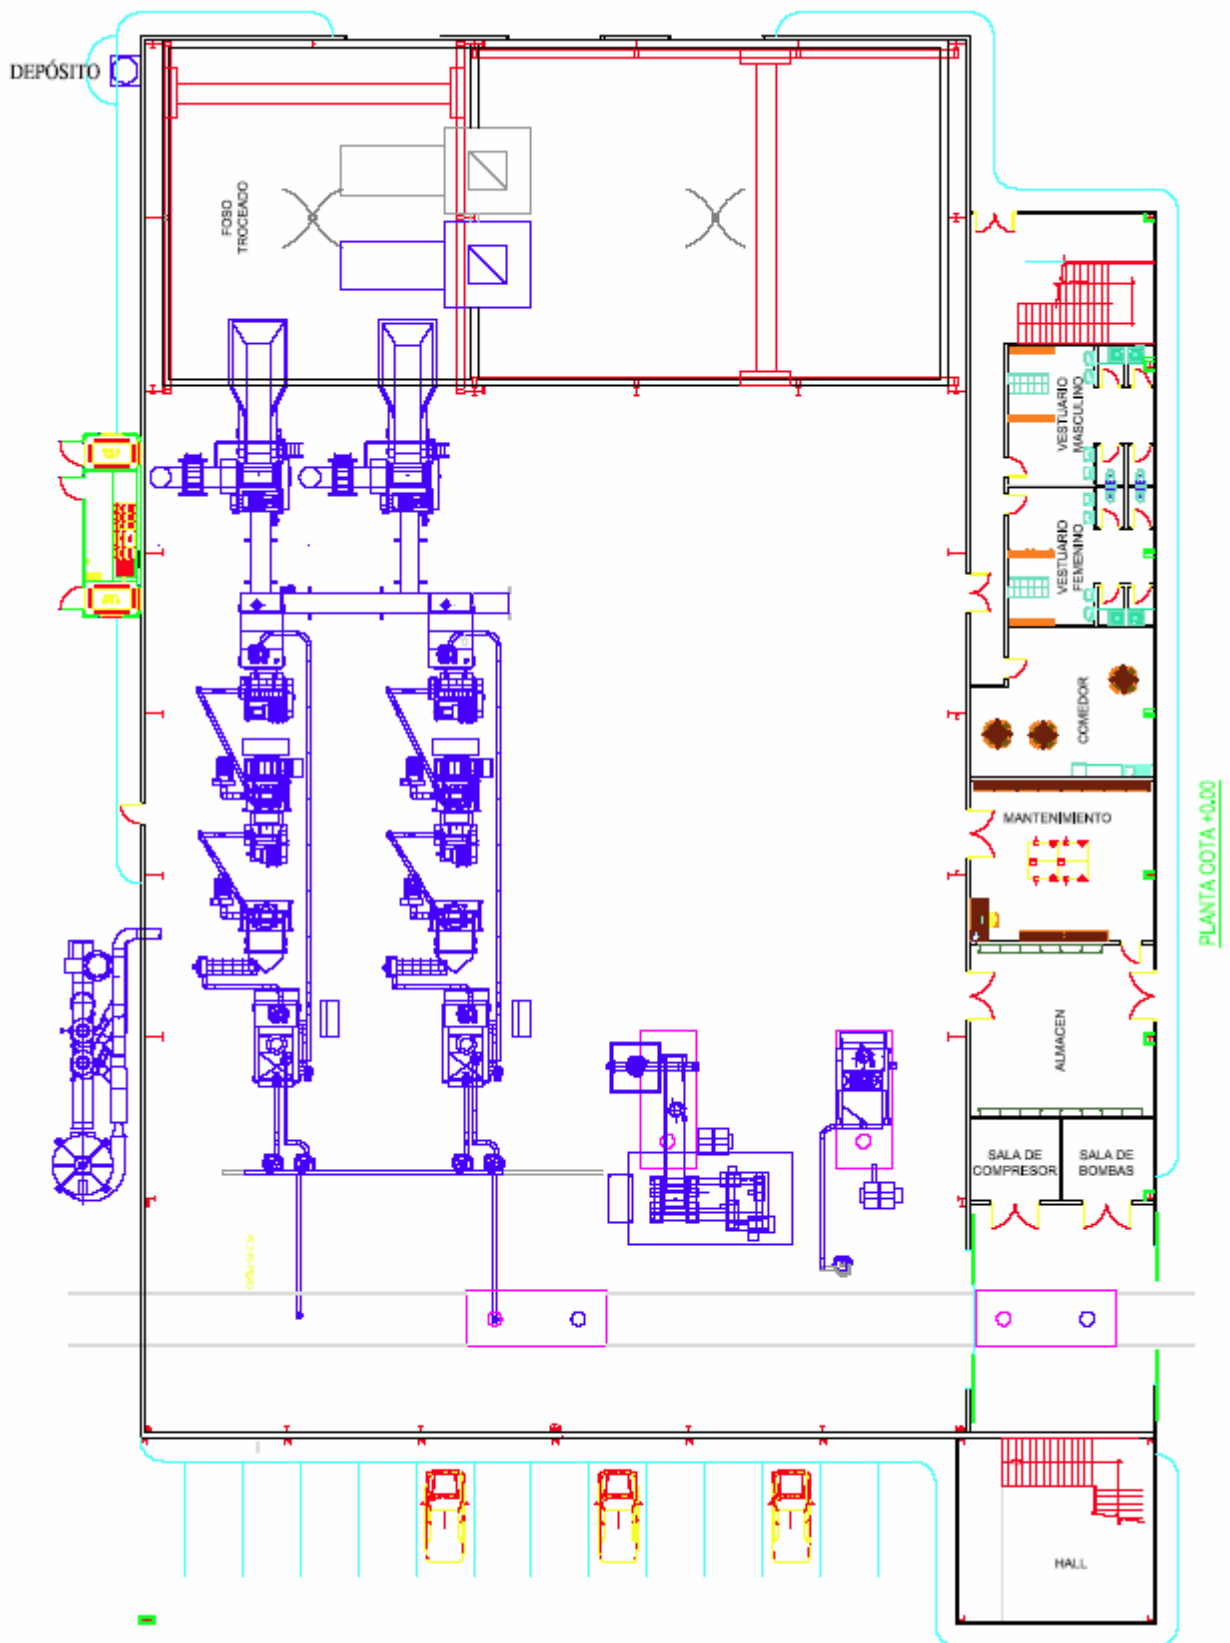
"Layout" de la planta de tratamiento de neumáticos
